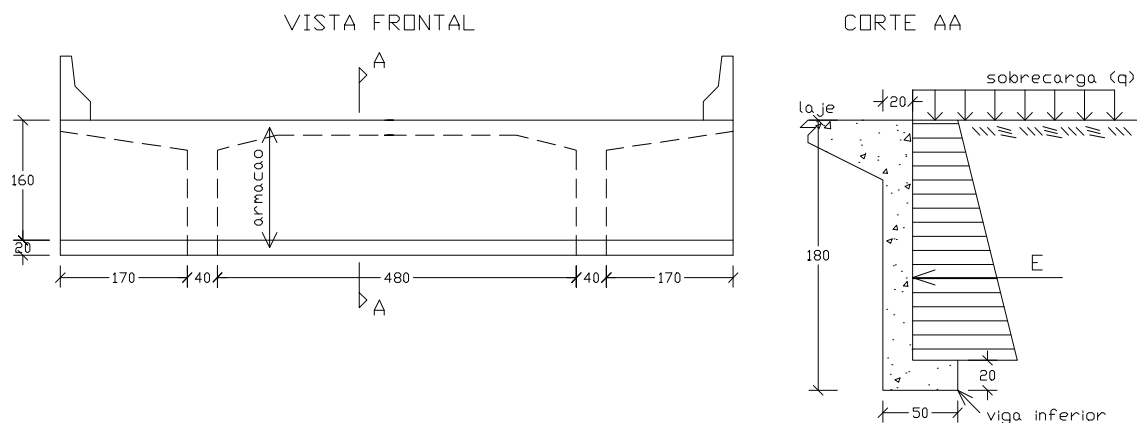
Carregamento na viga de fechamento devido ao aterro de acesso.
